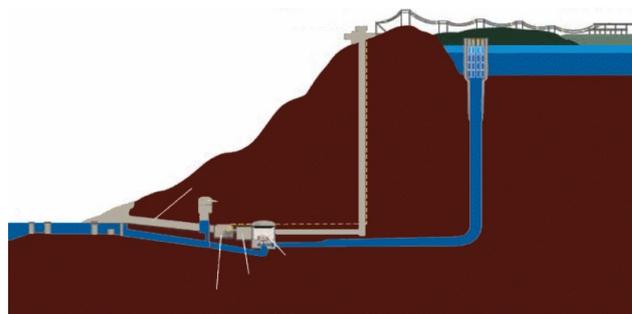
Illustration en plan de coupe d'une installation de pompage-turbinage
